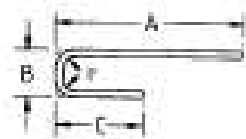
Diferentes ganchos y refuerzos transversales de acero para concreto armado. M.Y.H BANGASH, Structural details in concrete
